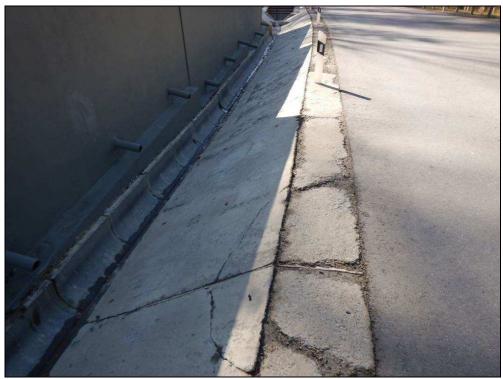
Фрагмент кювета с бетонными сборными лотками от ПК123+0,87 (н. СТ-51) до ПК124+78,58 (к. СТ-51), вид в сторону спус- от ПК124+78,58 (к. СТ-51) до ПК127+50, вид в сторону спуска. ка. Наблюдаются трещины по поверхностям откоса и обочины.
